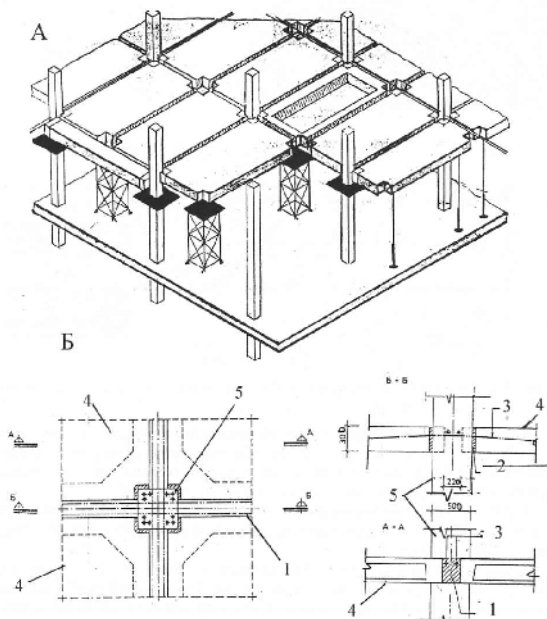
Каркас со скрытыми ригелями (КПНС): А – схема сборки; Б – узел плана перекрытия у колонны; 1 – монолитный ригель; 2 – шов омоноличивания; 3 – канатная натяжная арматура; 4 – плита перекрытия; 5 – колонна
